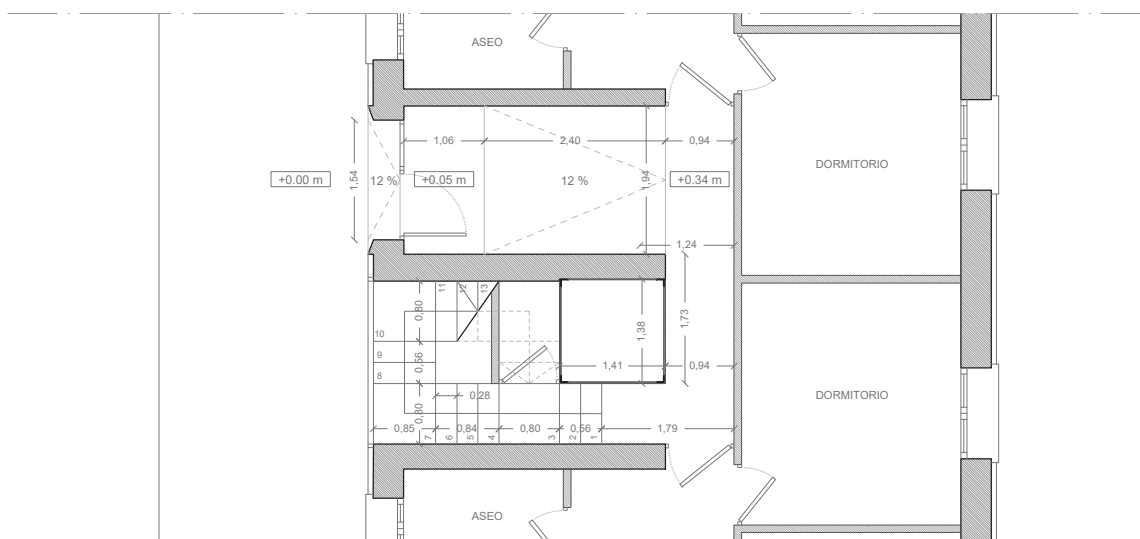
Zoom núcleo planta baja (e: 1/100).
